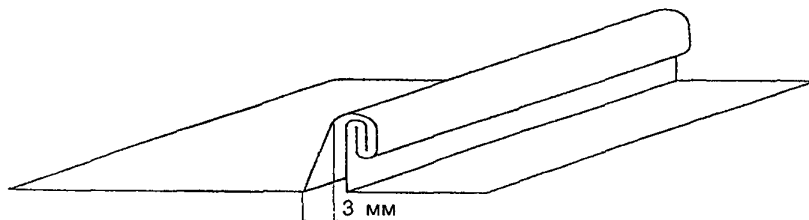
Невентилируемое покрытие с кровлей из медных листов
